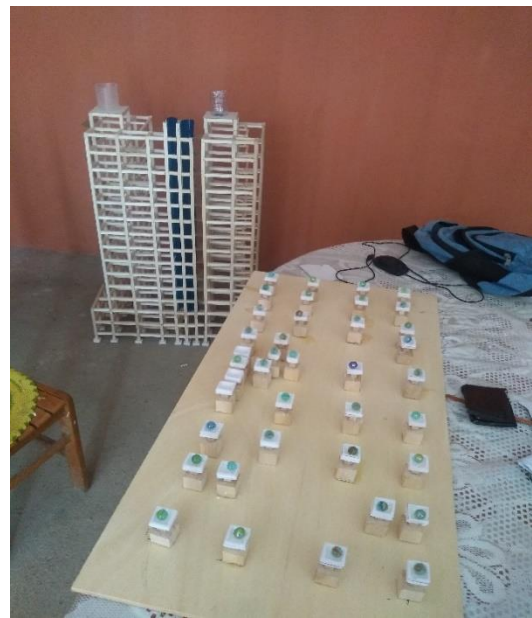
vista previa de zapatas y colocación de sistema de aislamiento
